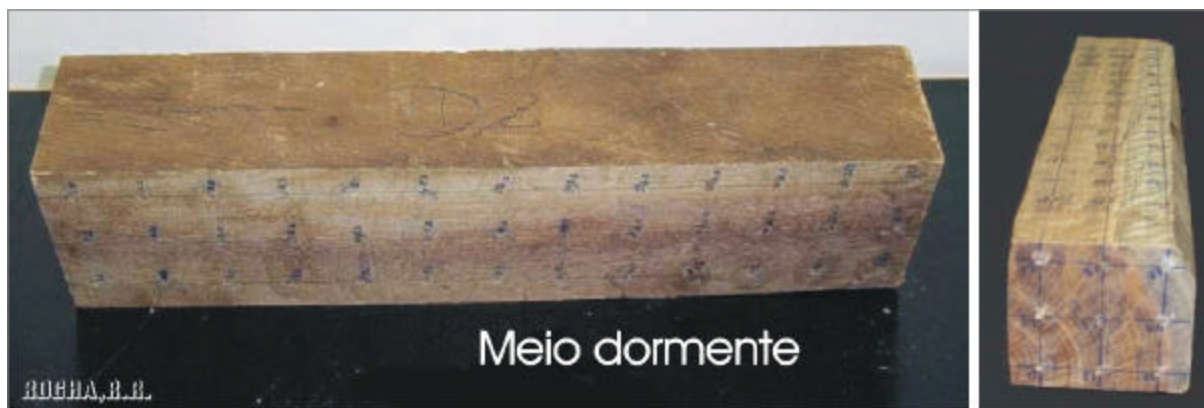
Características das amostras dos dormentes – aproximadamente metade de um dormente.
